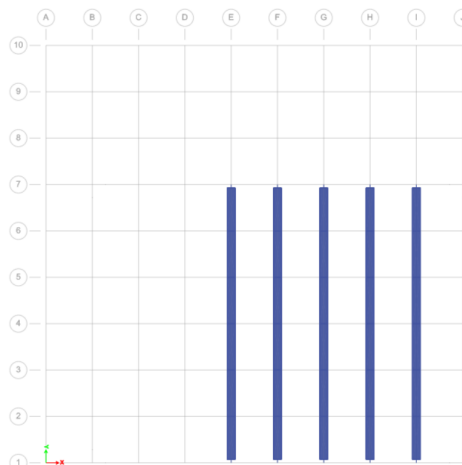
Un schéma représente la disposition des poutres principales (60x140) cm<sup>2</sup> à la terrasse
